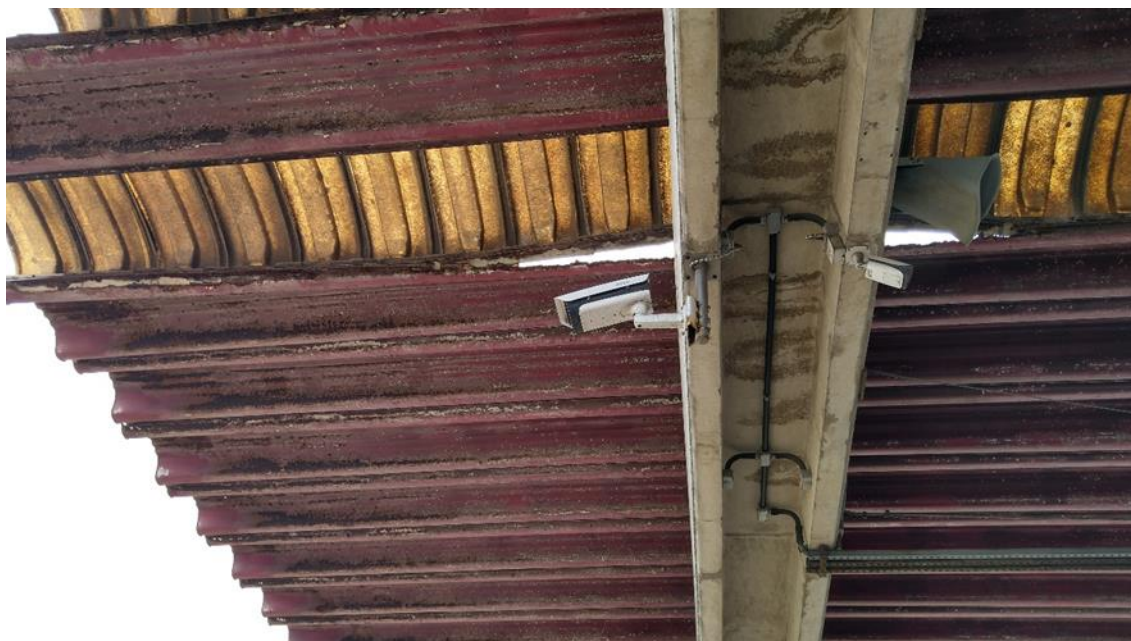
Câmeras instalada em viga da plataforma da Estação Porta Larga
